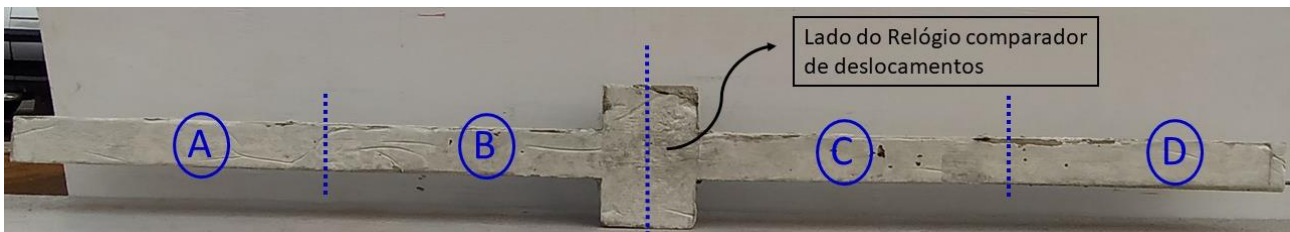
Divisões e nomenclaturas das armaduras de cada viga.
